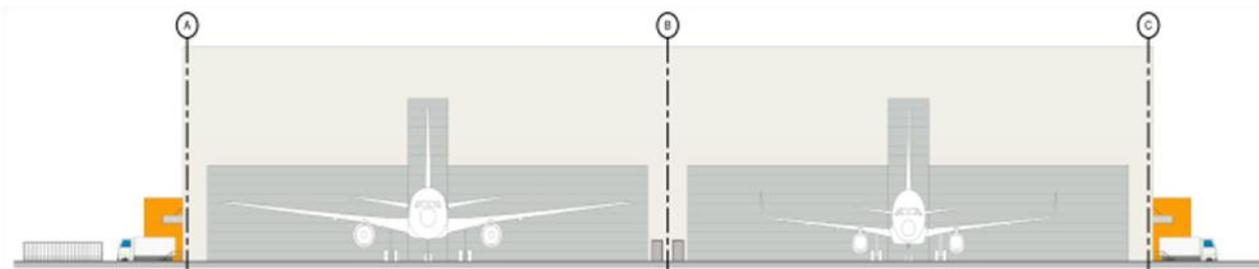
Intervento C2: Strutture area merci, prospetto edificio
